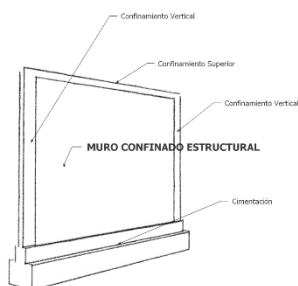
Lineamientos para el Diseño de Mampostería Confinada
